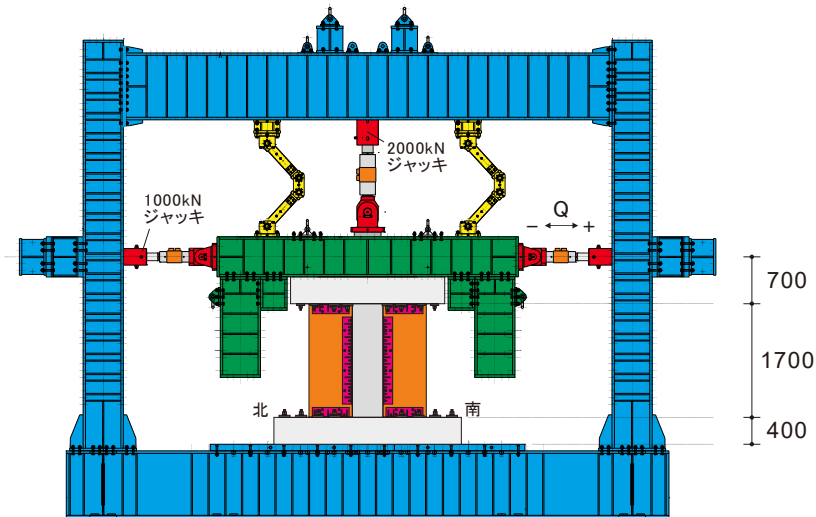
試験体 AS の加力装置図 (単位 : mm)
